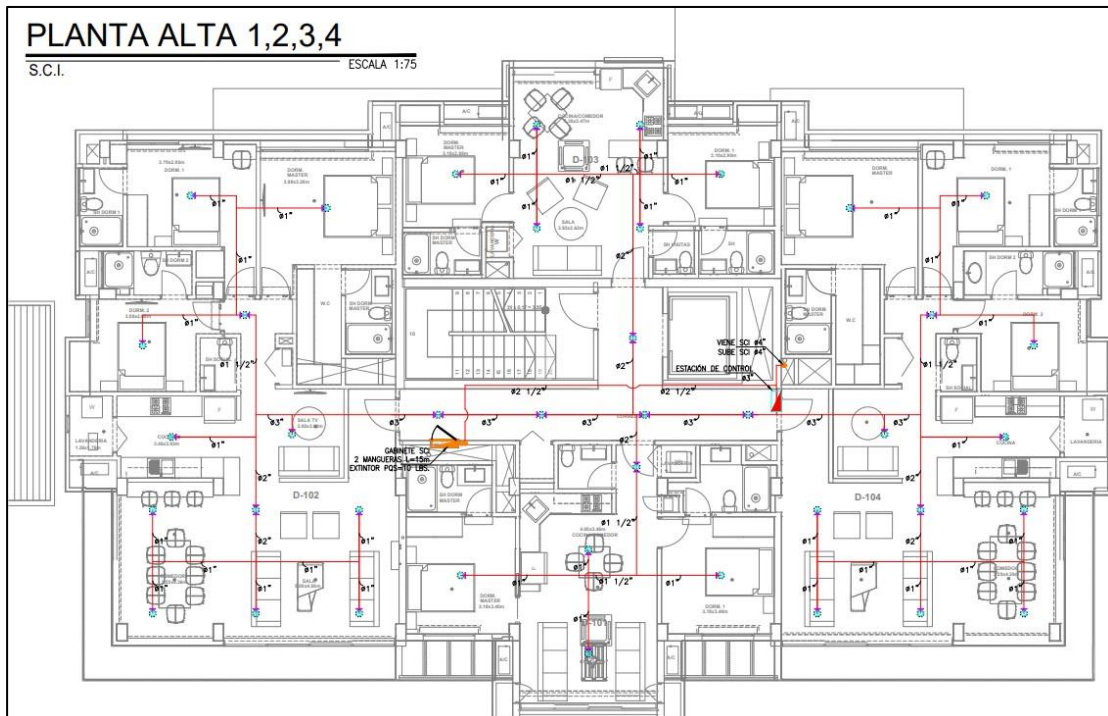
Plano SCI Planta Alta 1,2,3 y 4
